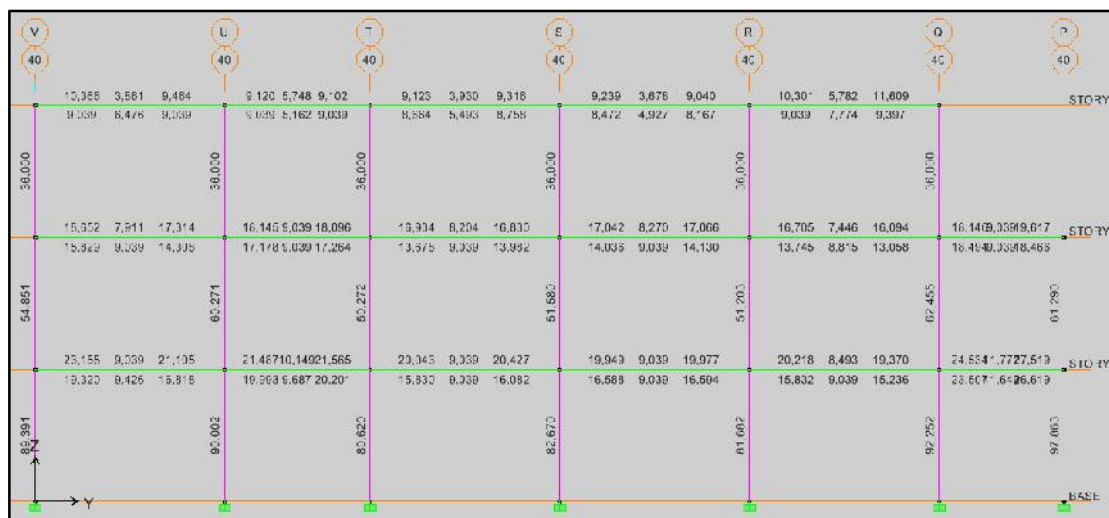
Acero en vigas pórtico 40, Consulta Externa I
